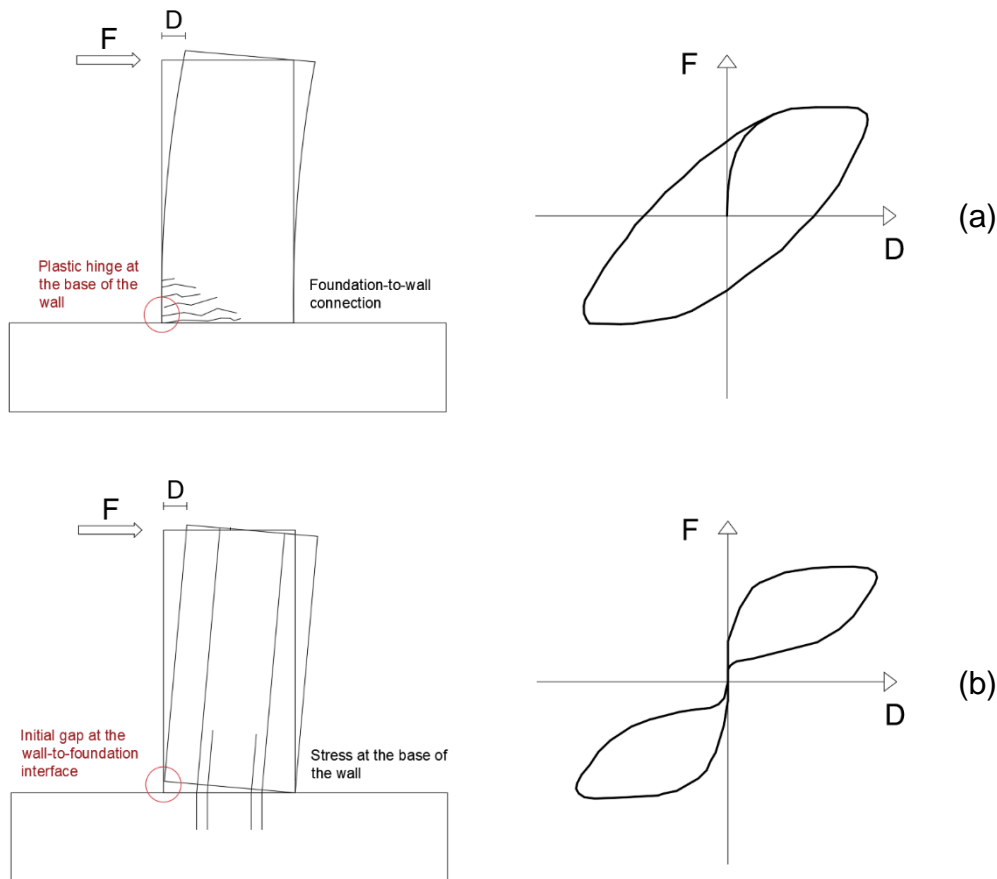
Confronto tra parete tradizionale gettata in opera e incastrata alla base (a) e parete con tecnologia rocking (b). / Comparison between traditional reinforced concrete wall (a) and rocking wall (b).
